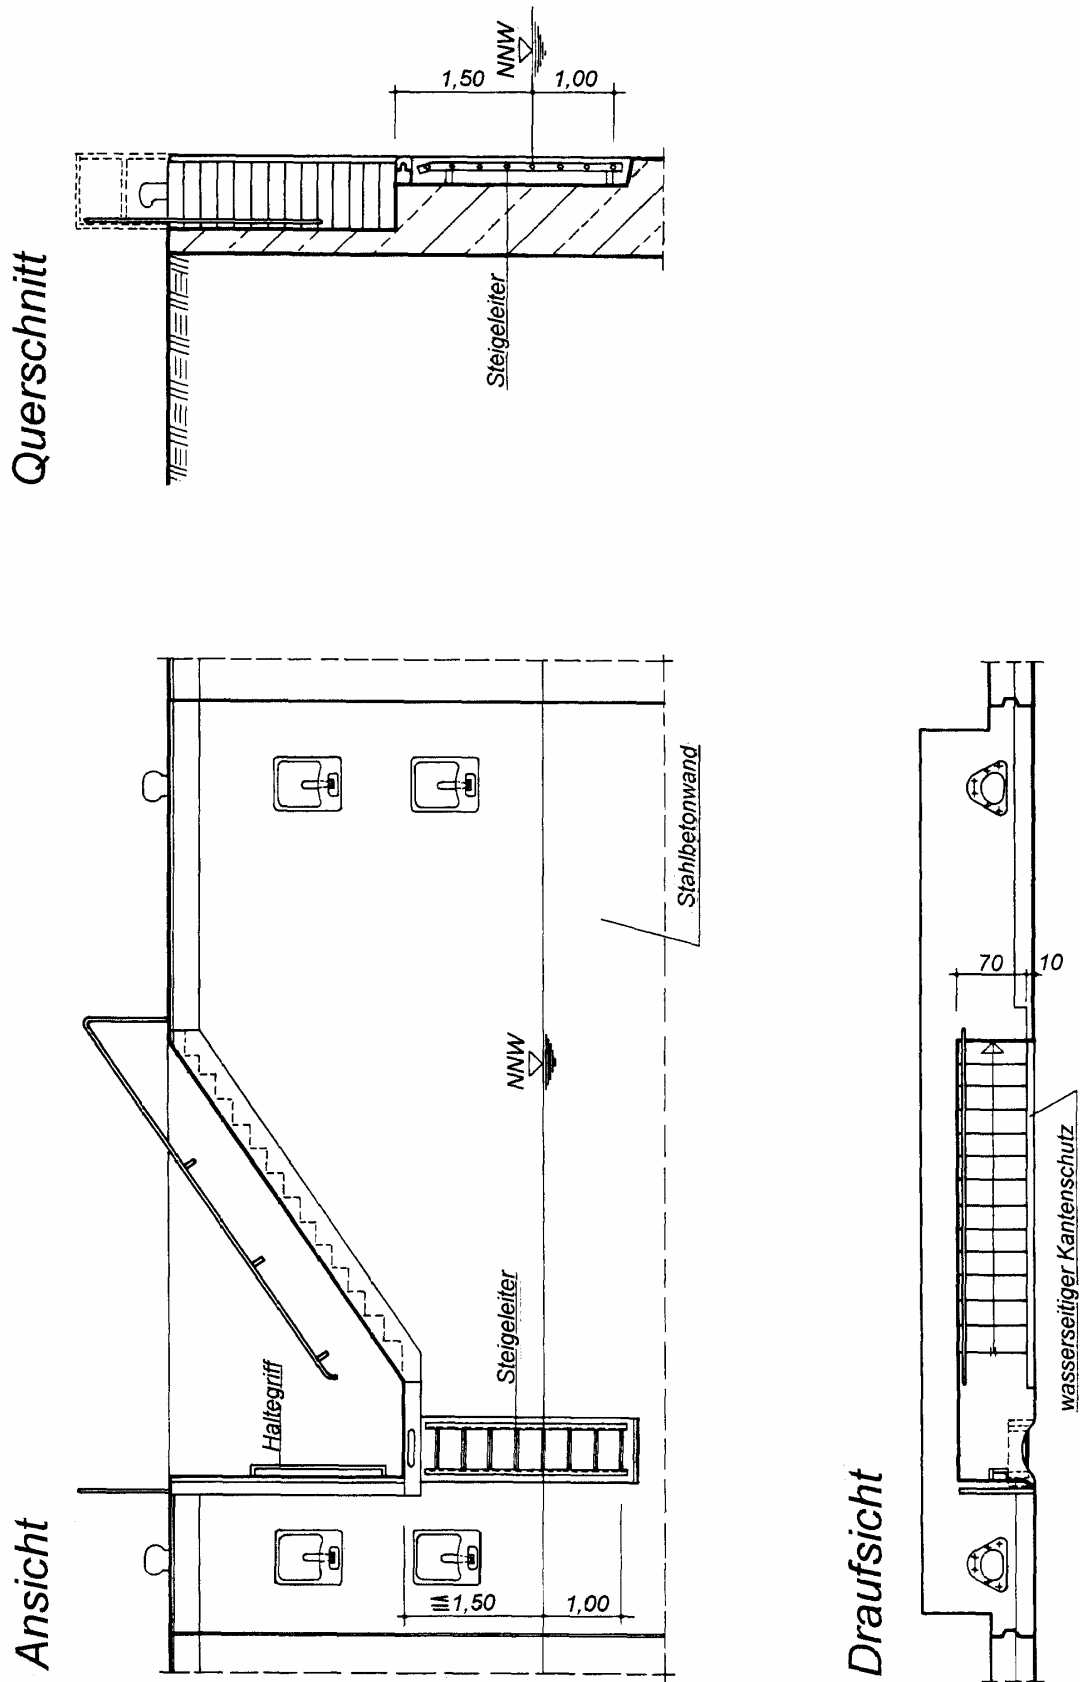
a Einläufige Treppe in einer Uferwand aus Stahlbeton
